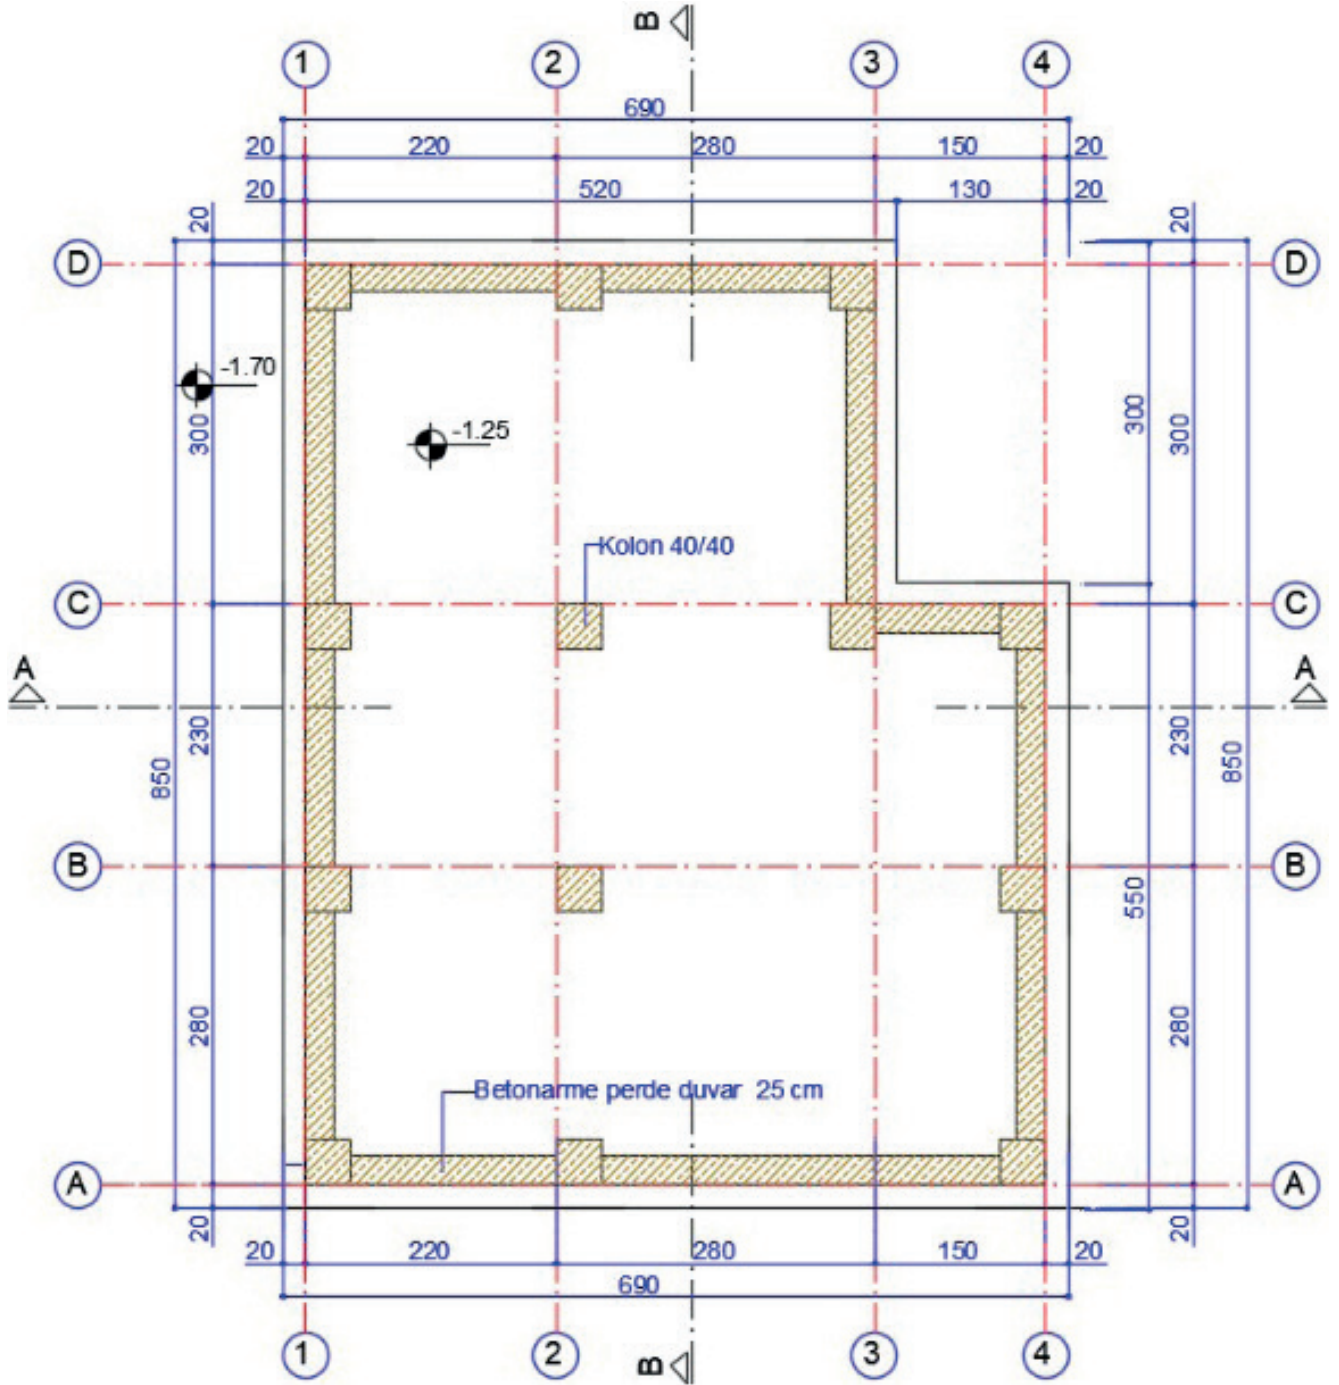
Sürekli (mütemadi) temel plan krokisi
